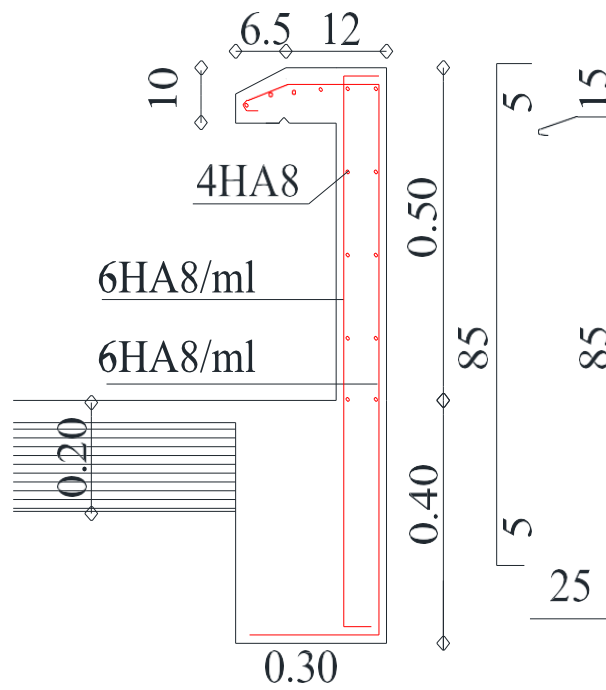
Schéma de ferraillage de l'acrotère.
